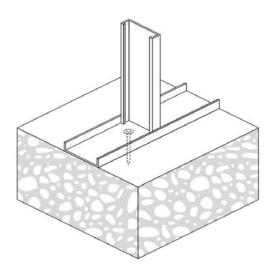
B (Vista de viga de cartón yeso a hormigón, desde ángulo superior )
